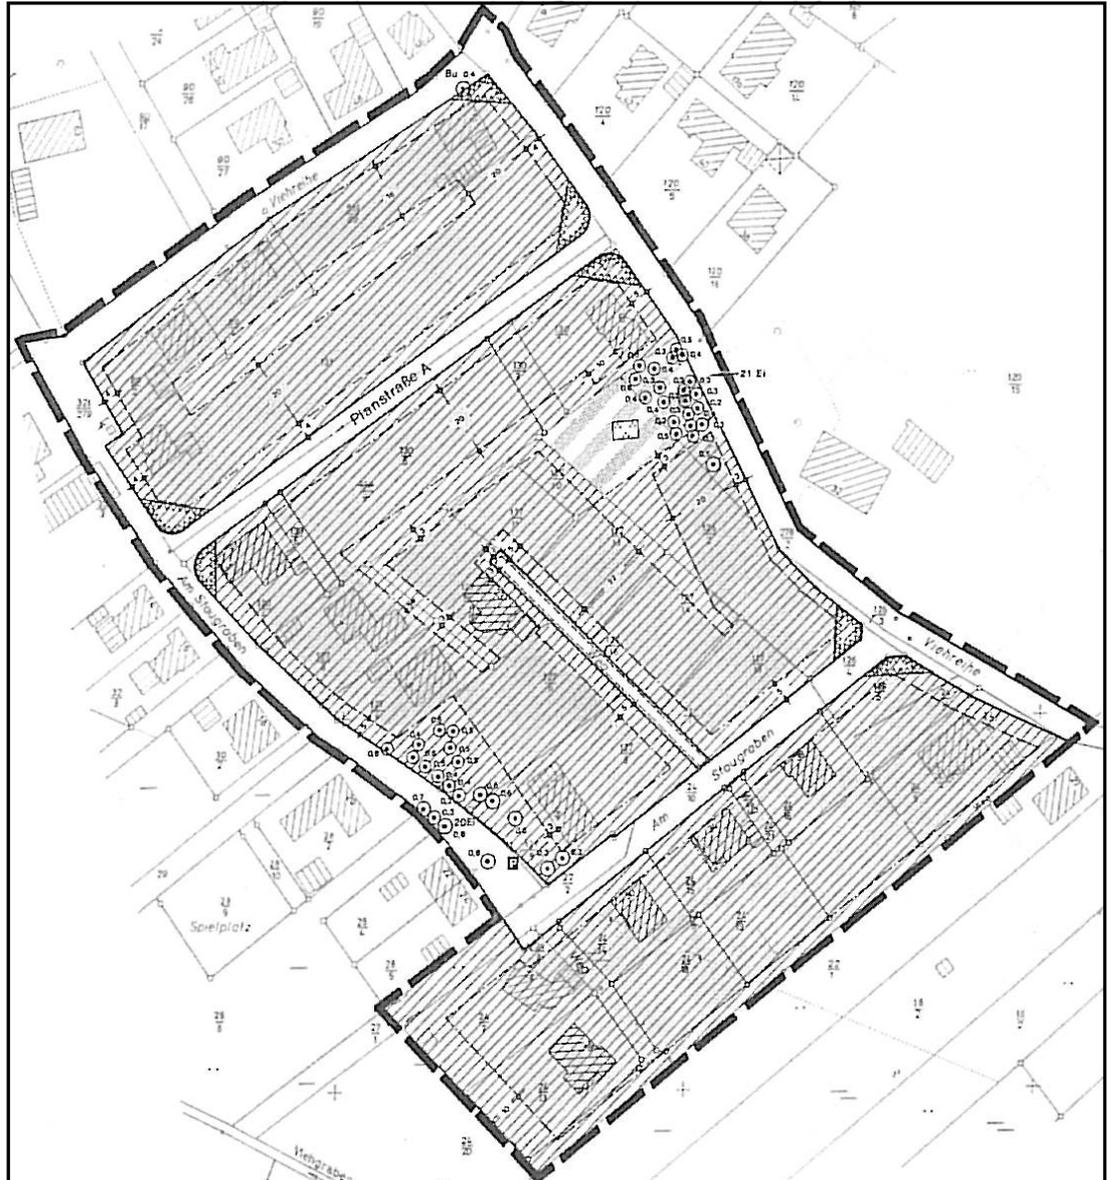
Bebauungsplan Nr. 59 „Viehreihe“, Gemeinde Lilienthal
